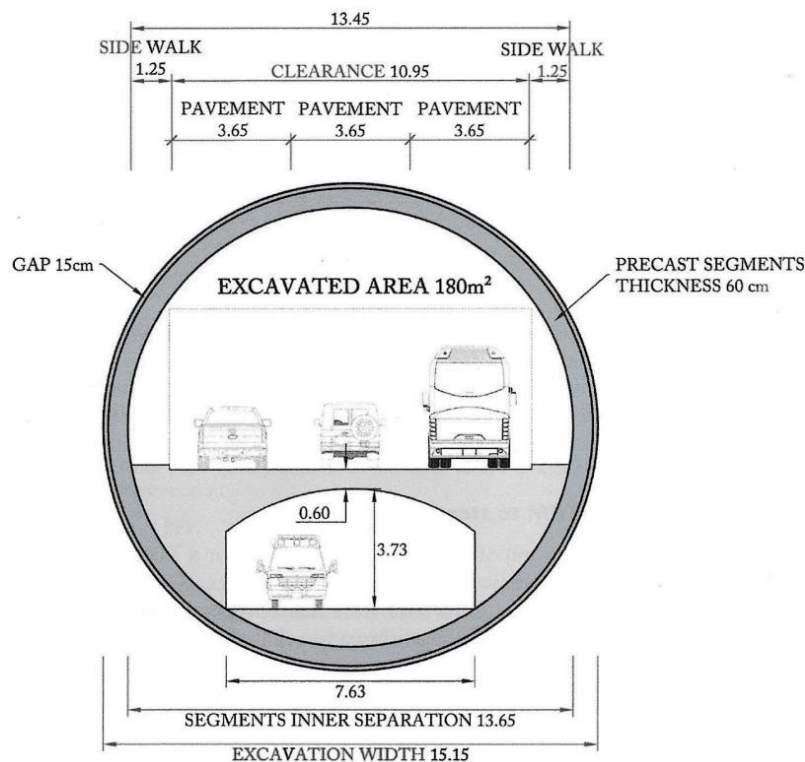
Galería de evacuación bajo la calzada de la Calle 30 Variante Sur de Madrid.
